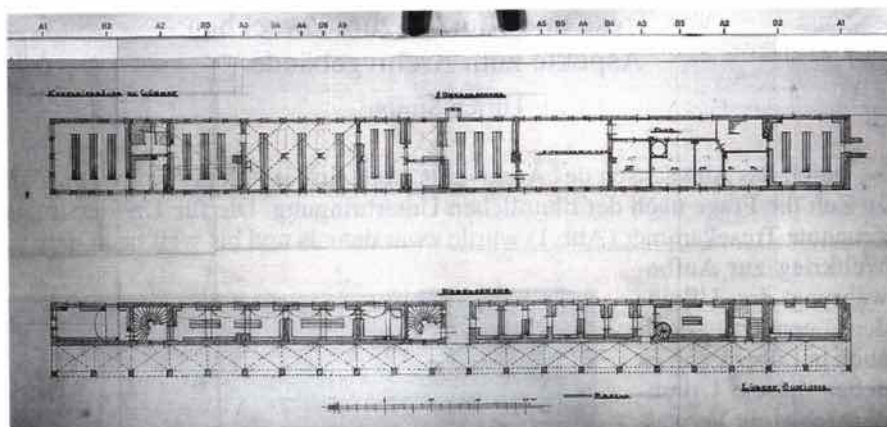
Kanzleigebäude, Breite Straße. – Grundriß EG und OG, 1902. – AHL: Plan-
